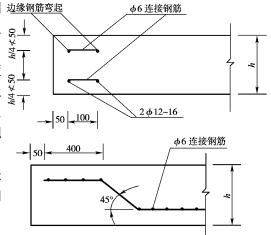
边缘钢筋布置(尺寸单位 :mm)
